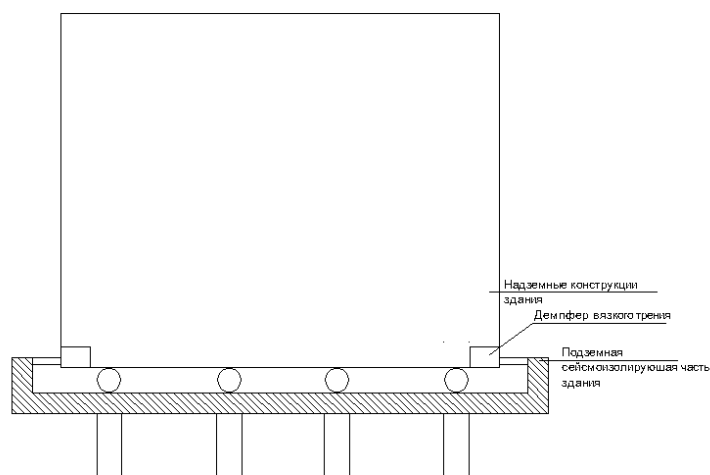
Конструкция сейсмоизолирующего фундамента с гидравлическим устройством
